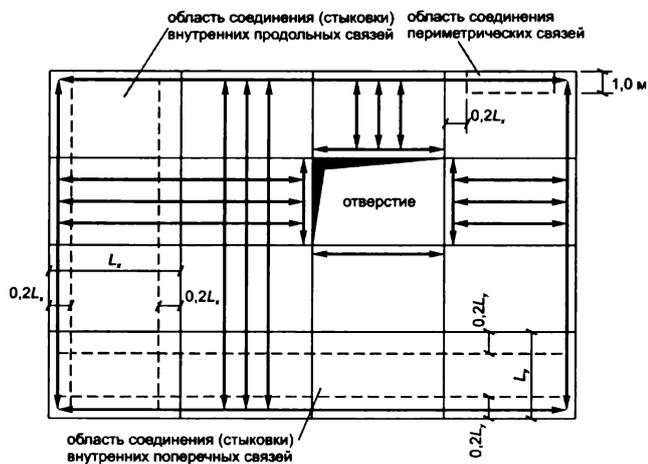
Схема размещения областей, в которых допустима стыковка продольных, поперечных и периметрических внутренних связей [14, 22]
